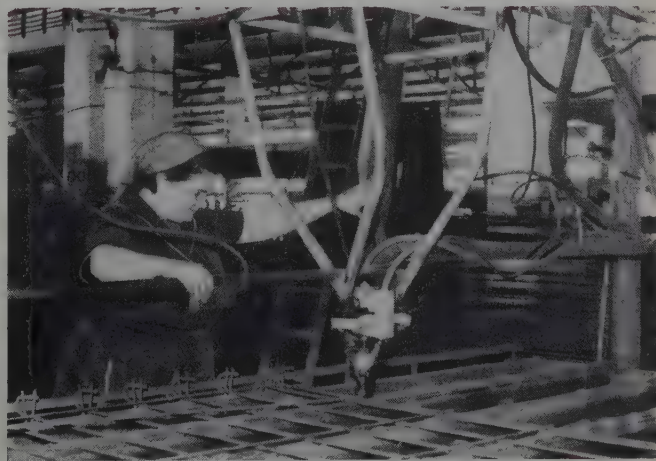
Schweißen der Bewehrung mit der Widerstandsschweißzange
